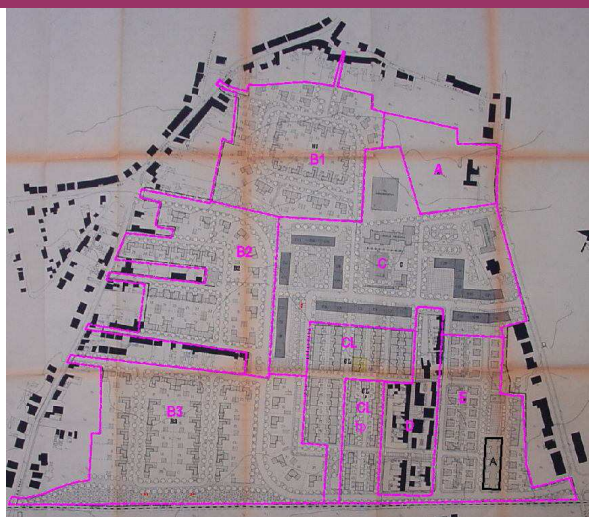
Planta de Implantação de PP da Zona Sul de Cantanhede
